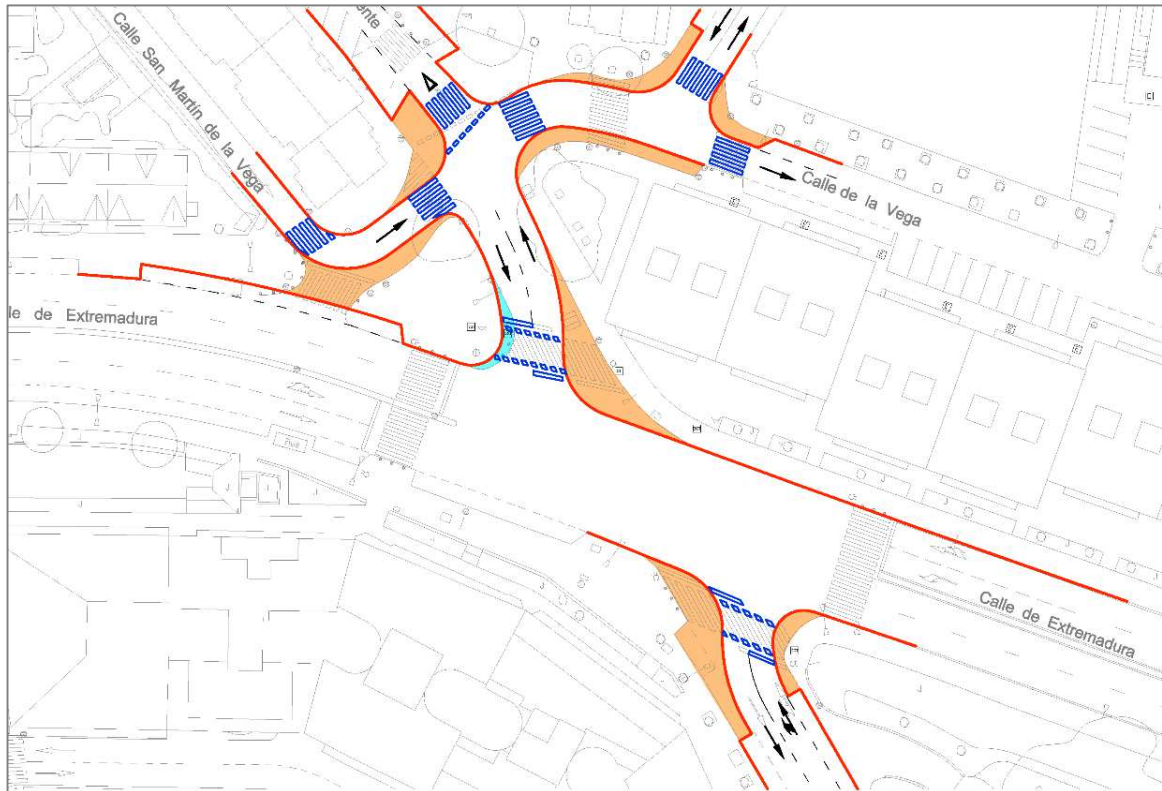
Propuesta actuación en la intersección de las calles Extremadura y La Fuente.
